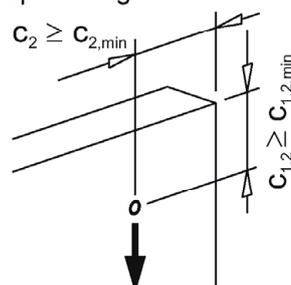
Einbauzustand Querbeanspruchung ohne Betonkantenbruch, ohne Rückhängebewehrung
